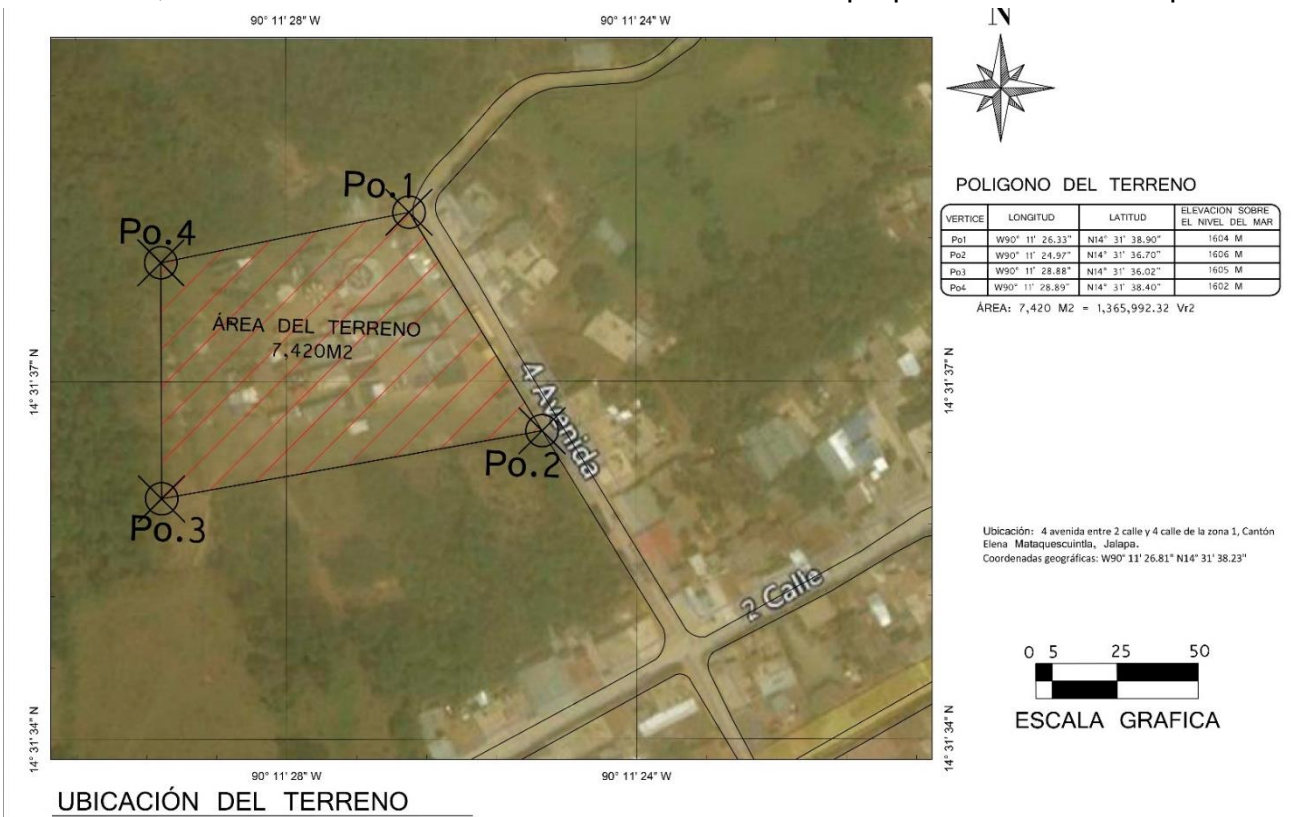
, Plano de ubicación del terreno, elaboración propia en fuente base AutoCAD CIVIL 3D, Bing 2018
